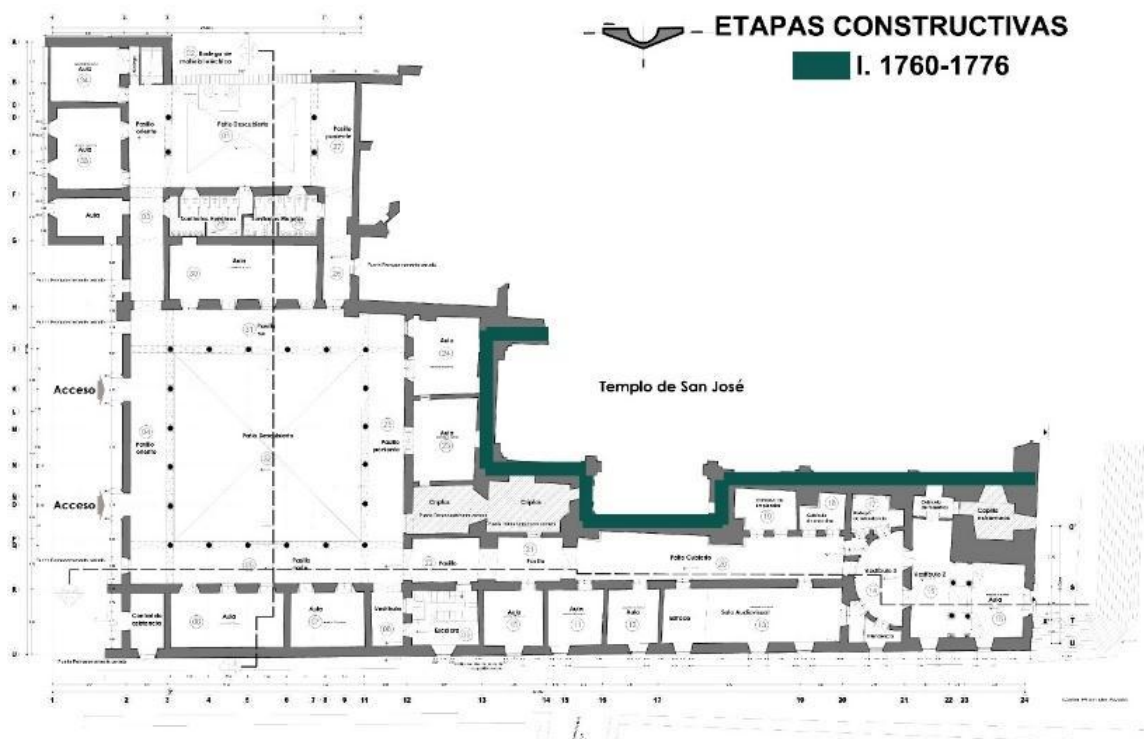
Primera etapa de construcción (Planta baja)¹²⁷
